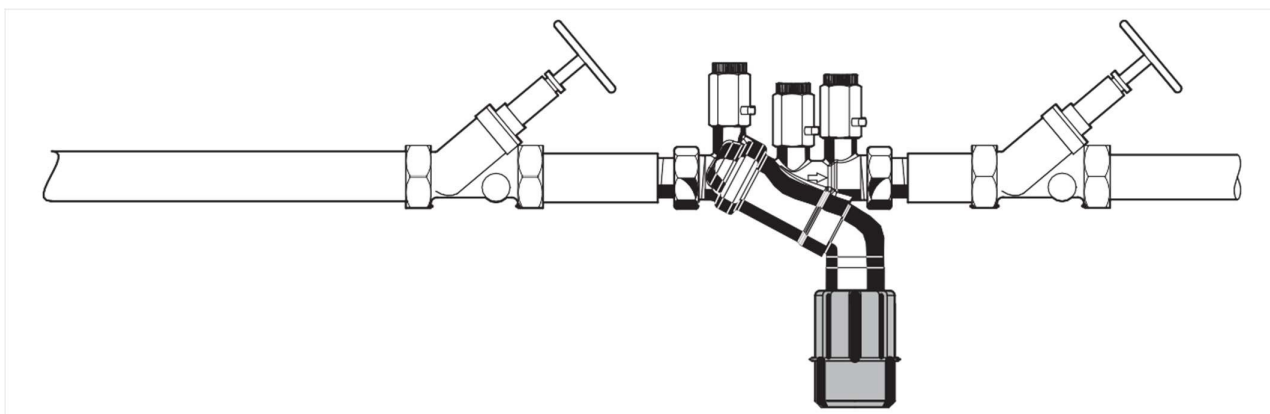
Exemple d'installation standard pour le dispositif antirefoulement
